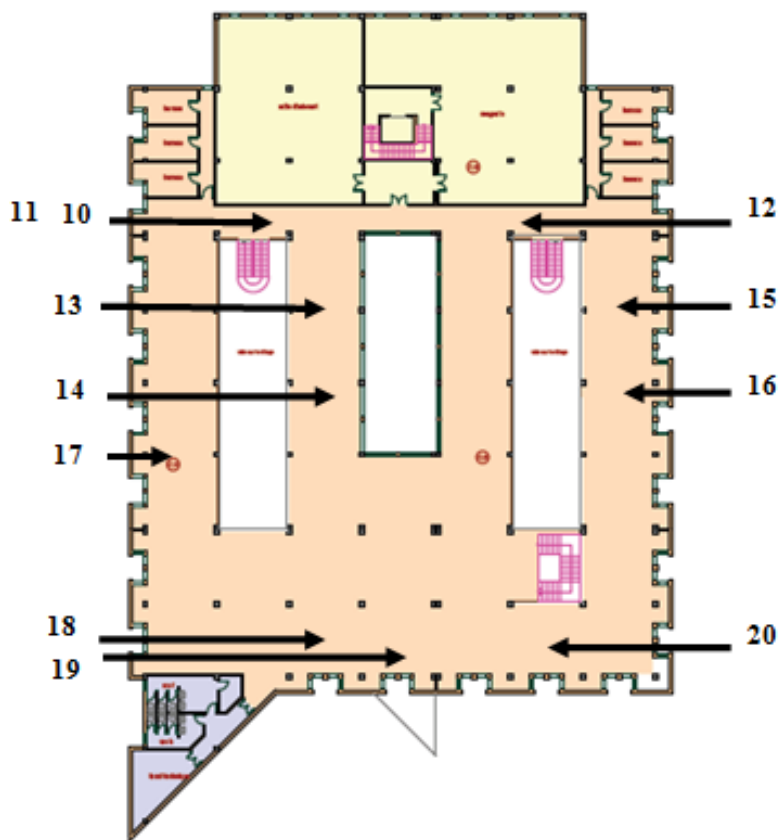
Plan 2<sup>ème</sup> étage
